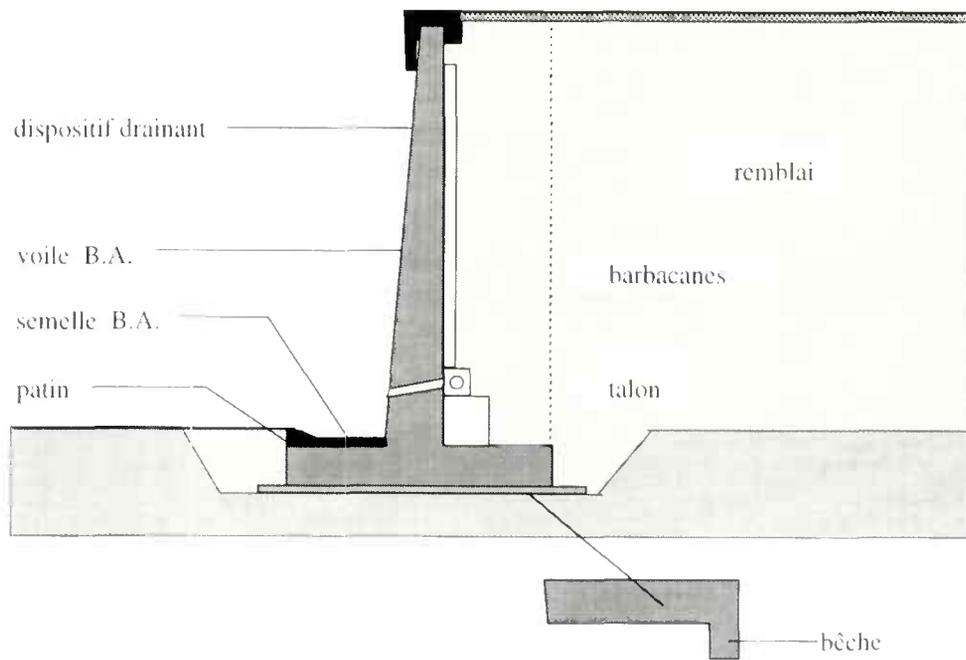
Mur en béton armé (ou mur cantilever)
